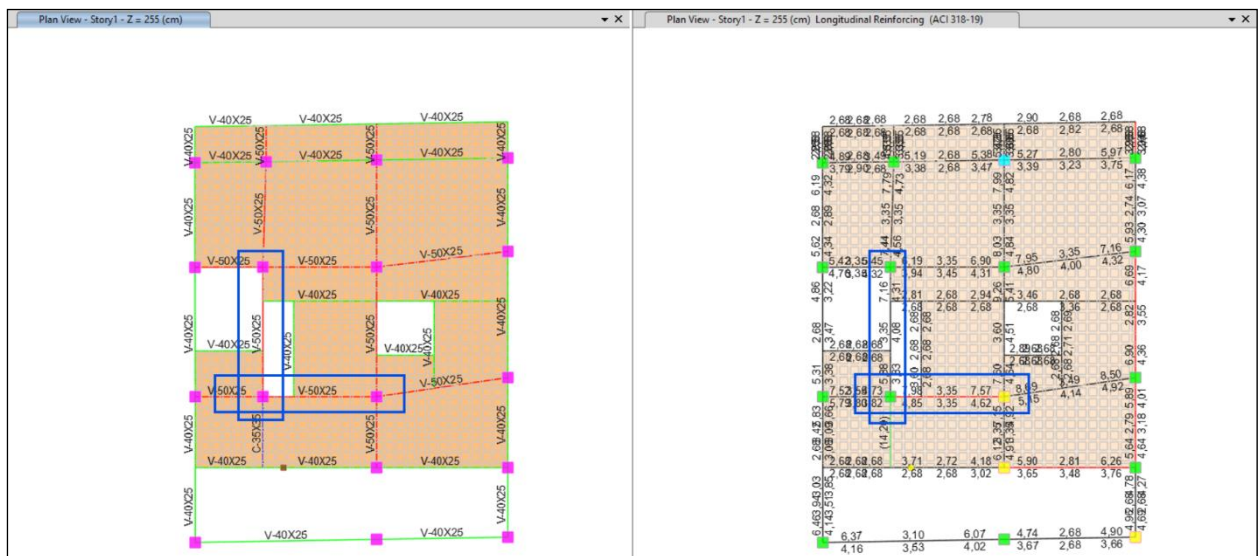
Acero a flexion en vigas de losa nivel 1, alternativa 1 [Autor]
